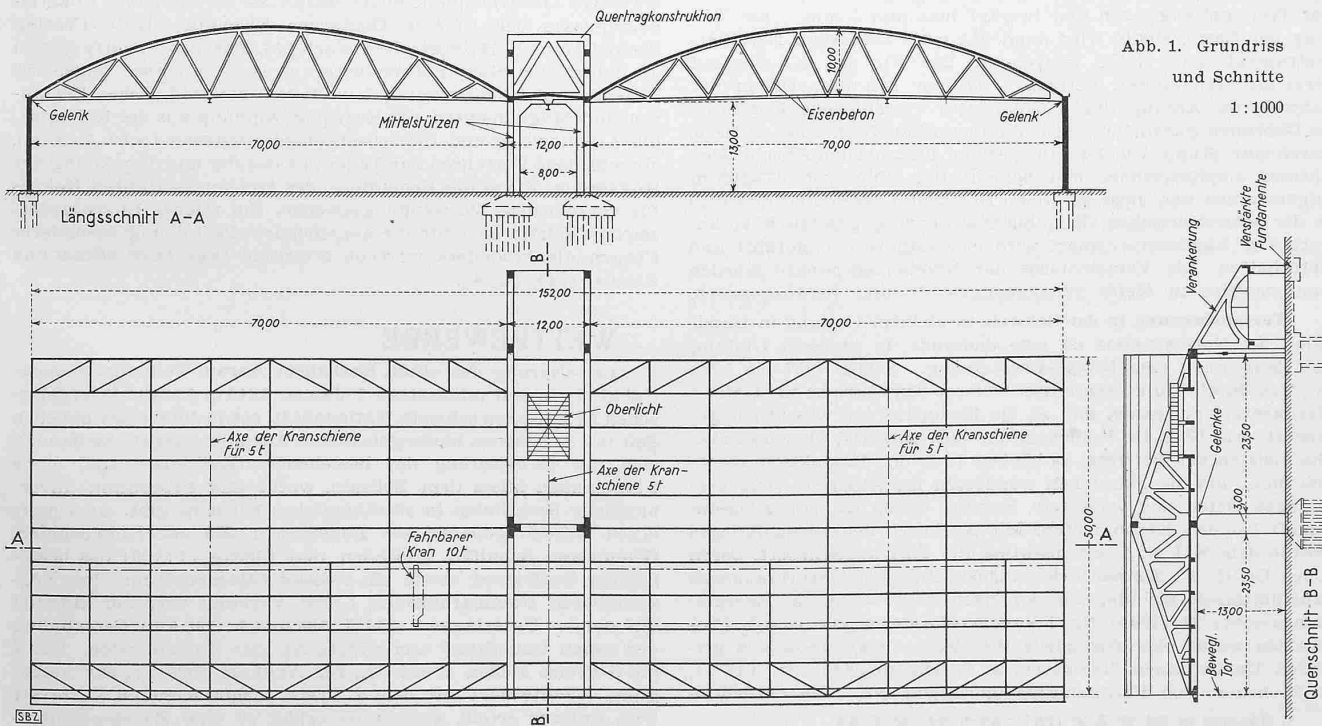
Grundriss und Schnitt 1:1000
